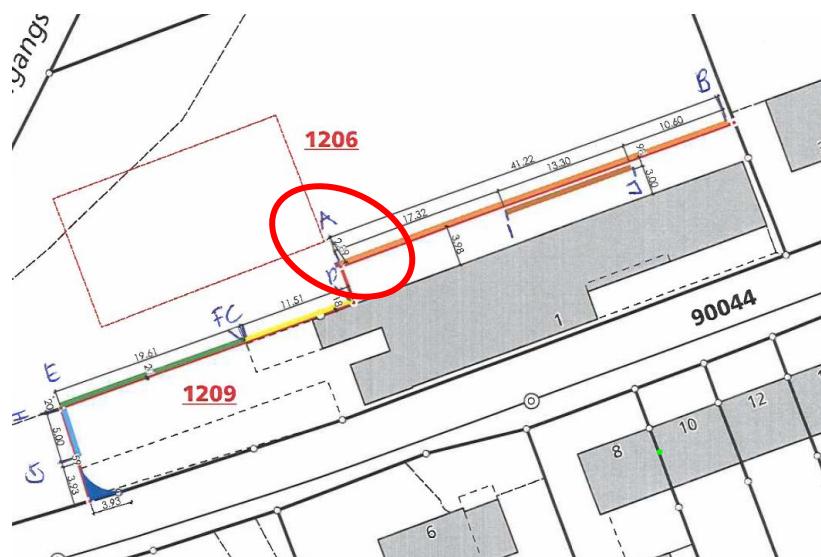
Situationsplan mit dem Näherbaurecht von 2.89m (rot eingekreist)
